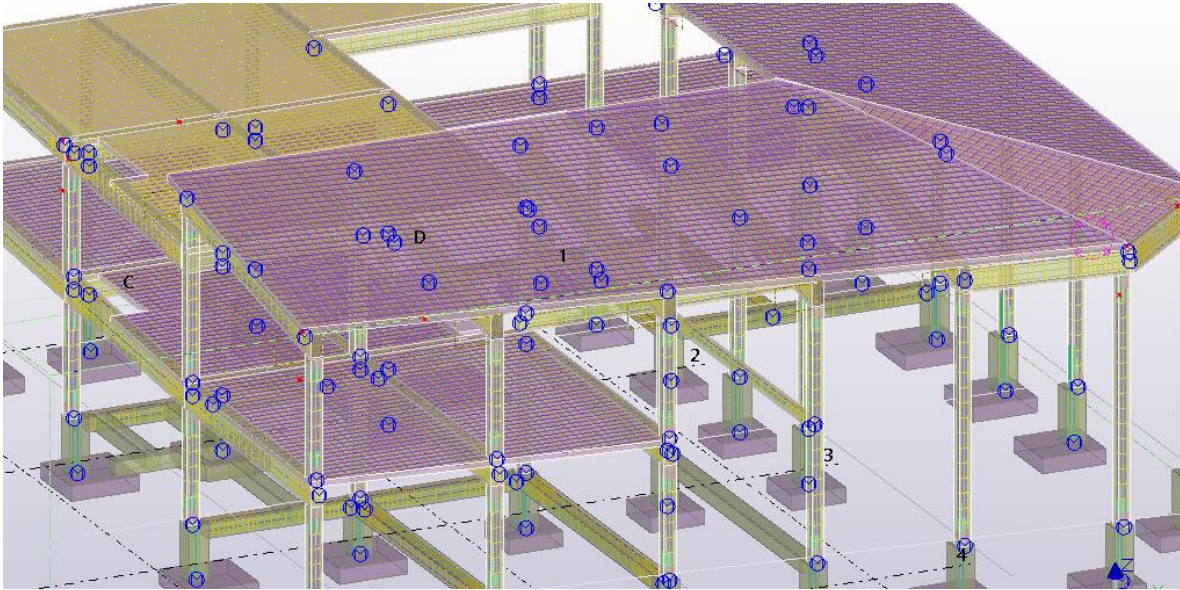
Vista del modelo completamente reforzado utilizando Tekla®
